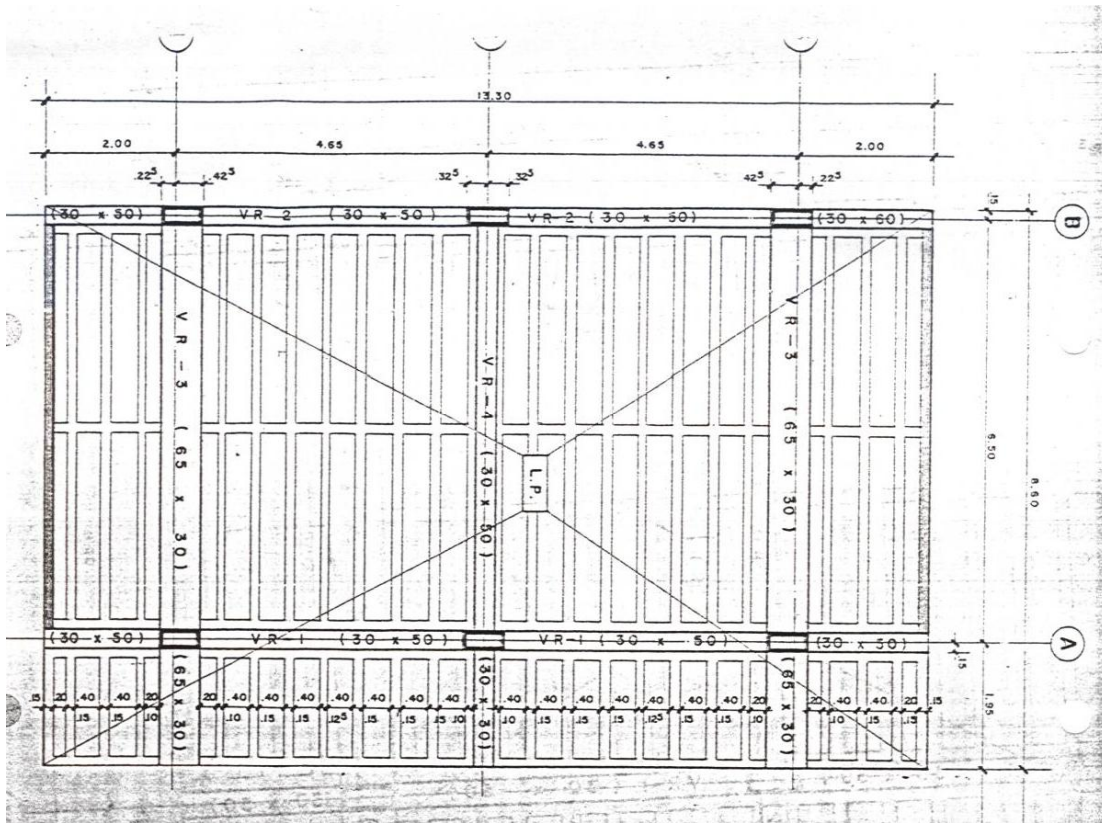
Envidado losa piso. Modulo de Barrio.
